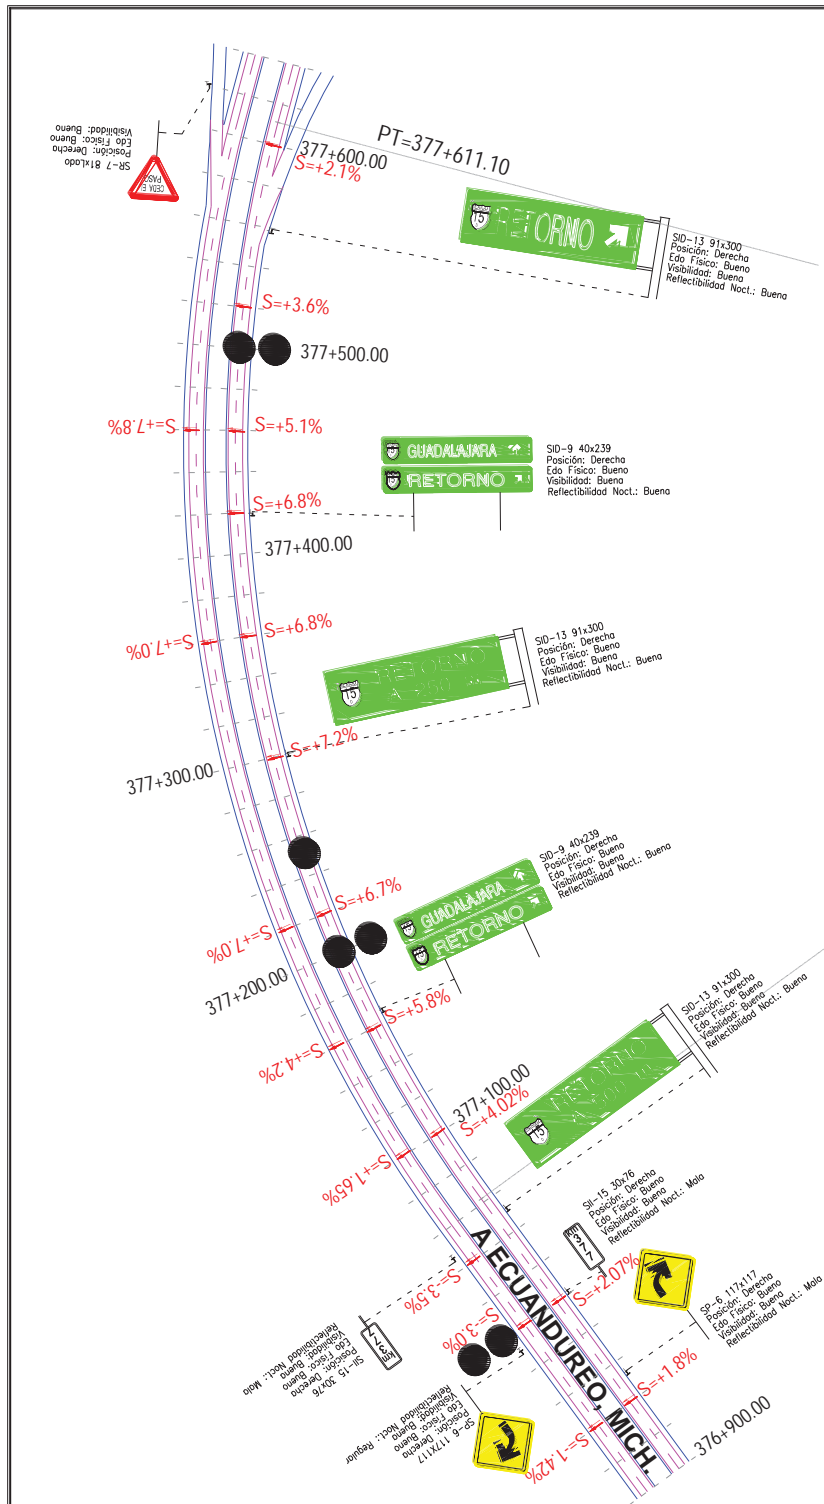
Planta y concentrado de accidentes ocurridos del km. 377+000 al km 377+500
